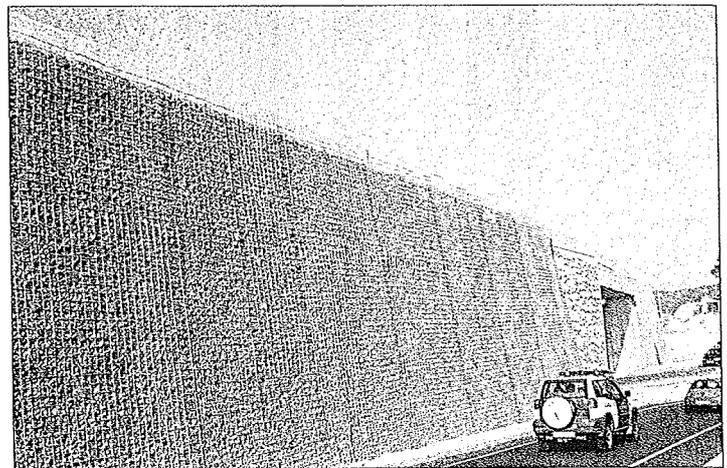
Bewehrte Böschung mit Facingsystem Muralex in Spanien
